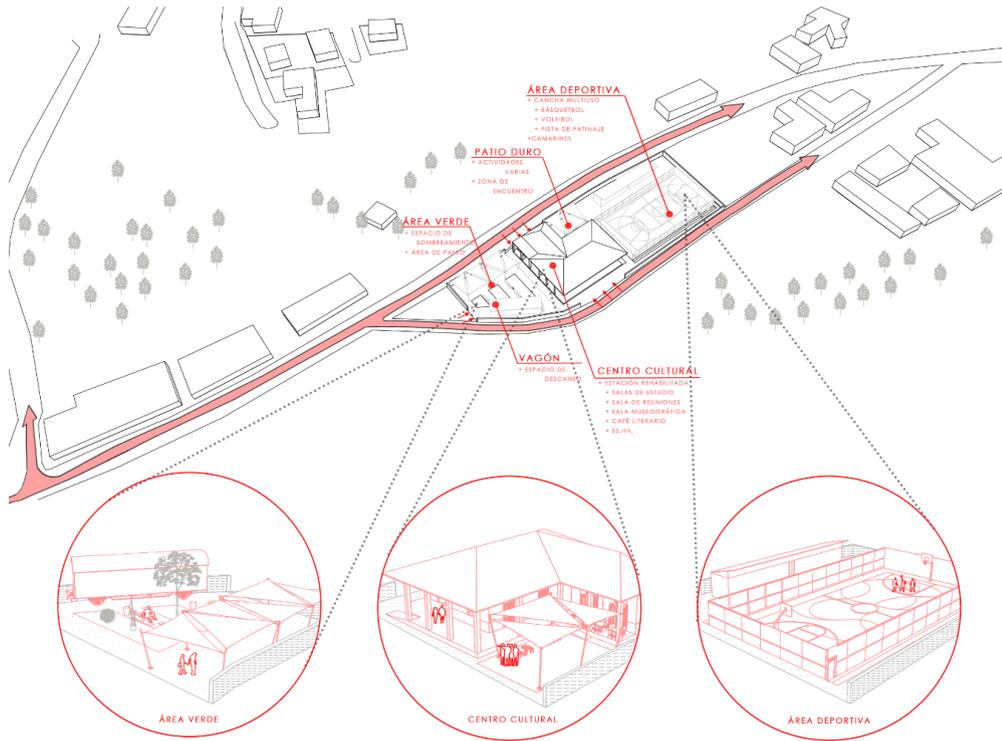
| Plan Maestro. Fuente: elaboración propia.
